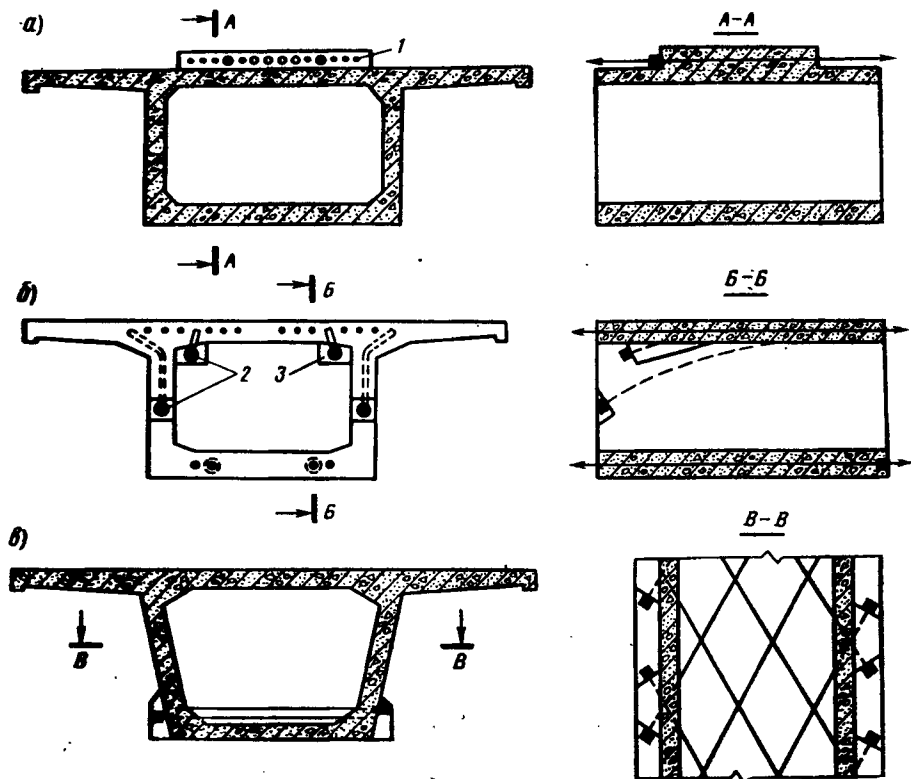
Схемы анкеровки продольной напрягаемой арматуры в блоках:
